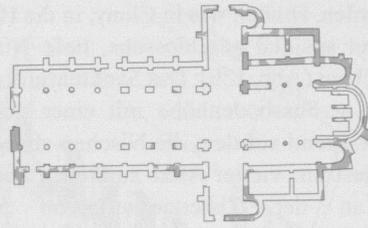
Cluny, Bau II (Abb. 4), hypothetische Grundrissrekonstruktion nach Ch. Sapin (Entwurf M. Untermann). M. 1:1000.
